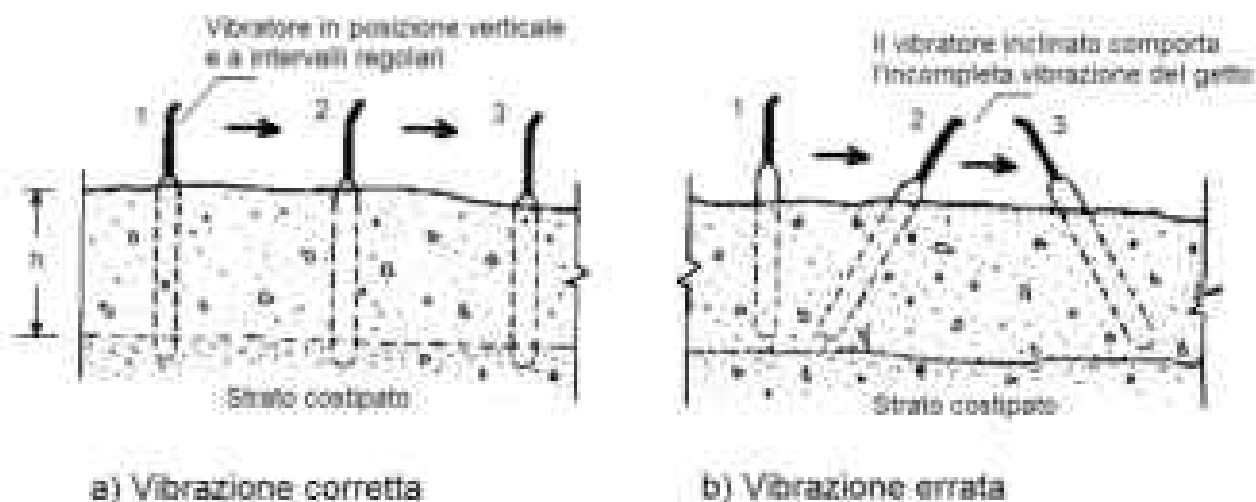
Esecuzione del getto e modalità di costipazione mediante vibrazione interna
